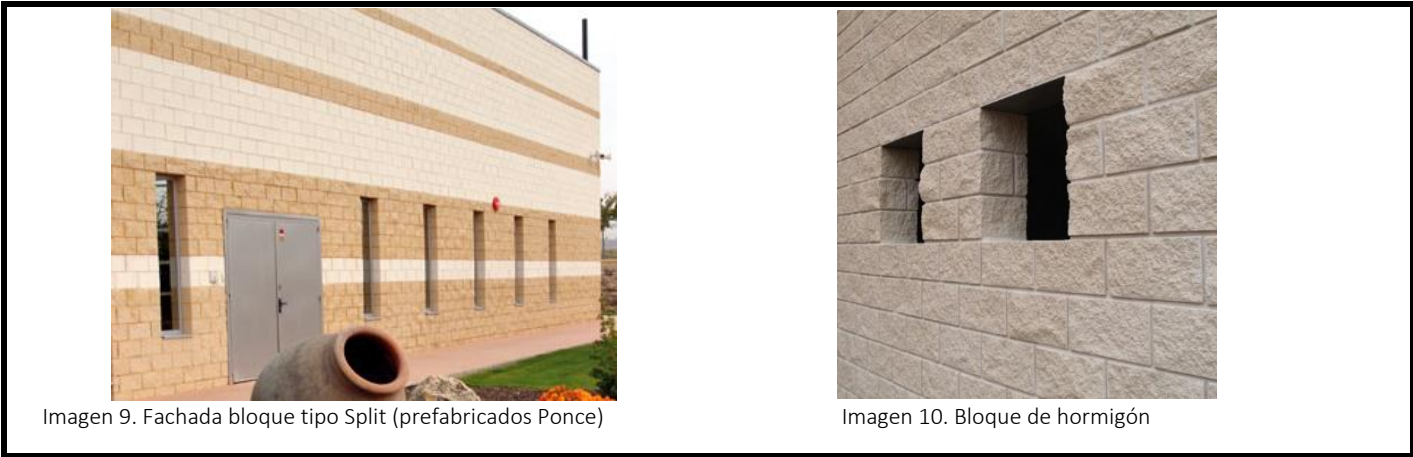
Fachada bloque tipo Split (prefabricados Ponce)
